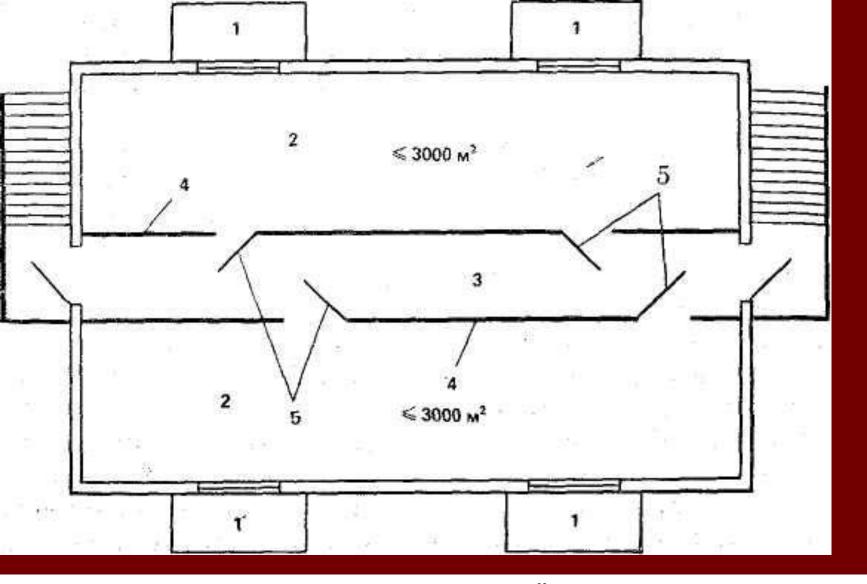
Схема размещения пожароопасных помещений в подвальных помещениях:
